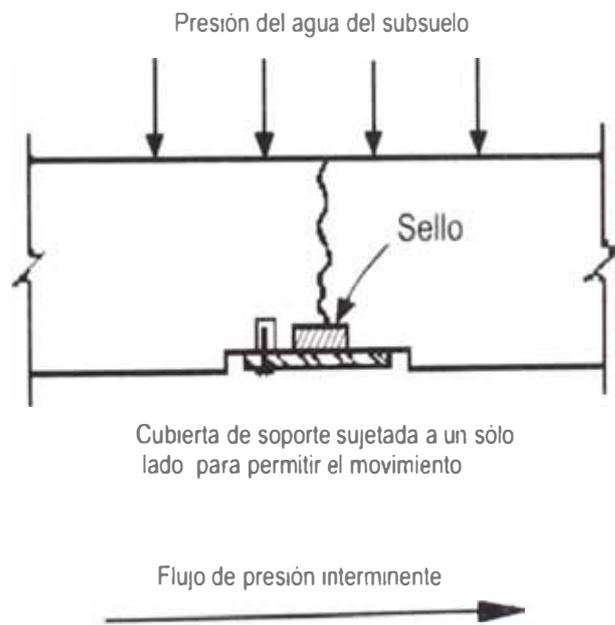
Reparación de fisuras mediante el uso de una cubierta de soporte para mantener el sellador en su lugar en contra de la presión externa
